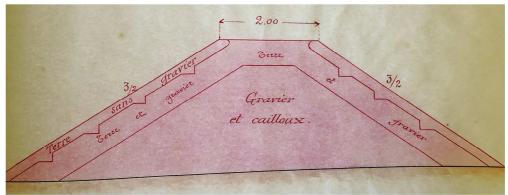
Profil type de la digue pour sa reconstruction, 1897 (AD 73 – 40SPC 28)
